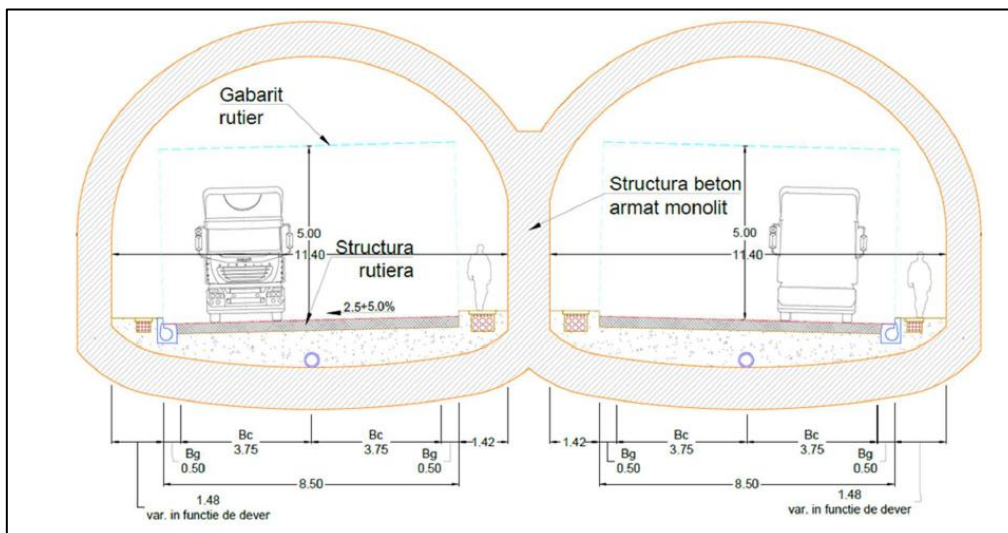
Secțiune transversală Tunel Artificial tip boltă – 2 benzi/sens (PTT02)
